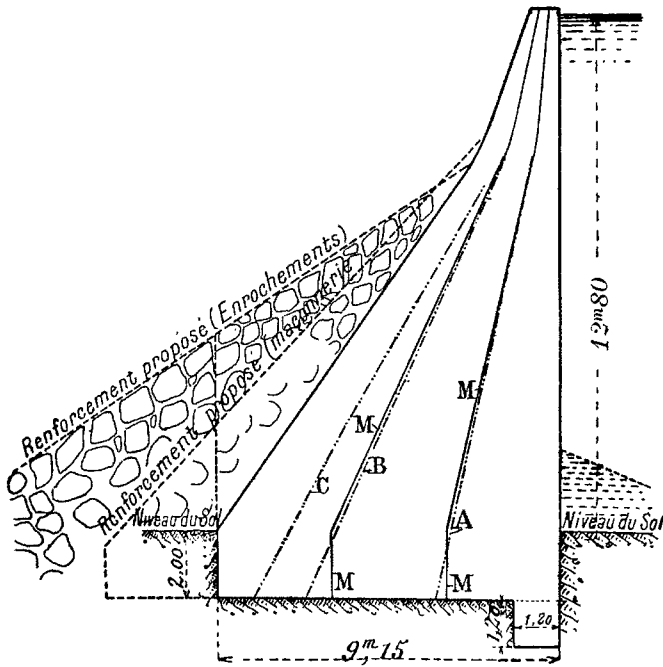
Coupe transversale du barrage d'Austin avec indication du renforcement proposé.
